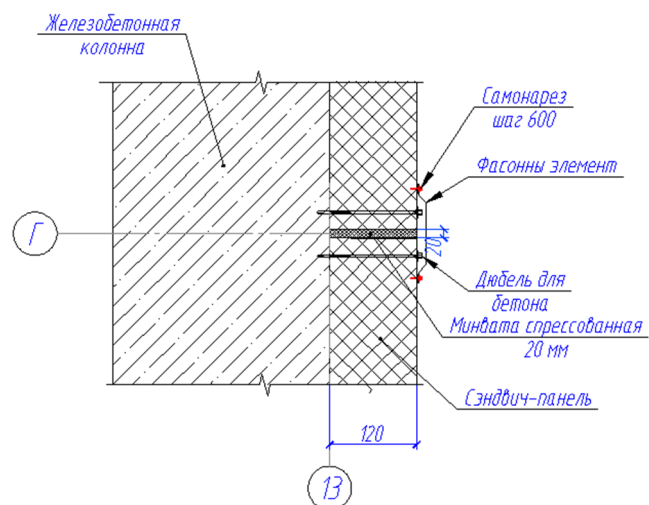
Узел крепления панели к колонне железобетонной каркаса
